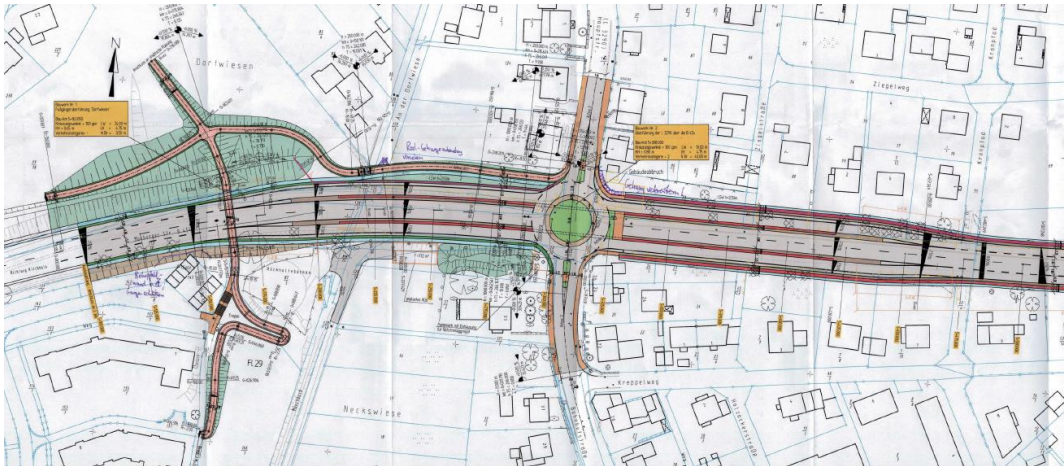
Lageplan 2 des 3. Bauabschnitts mit Kreisverkehr.¹⁸⁸
